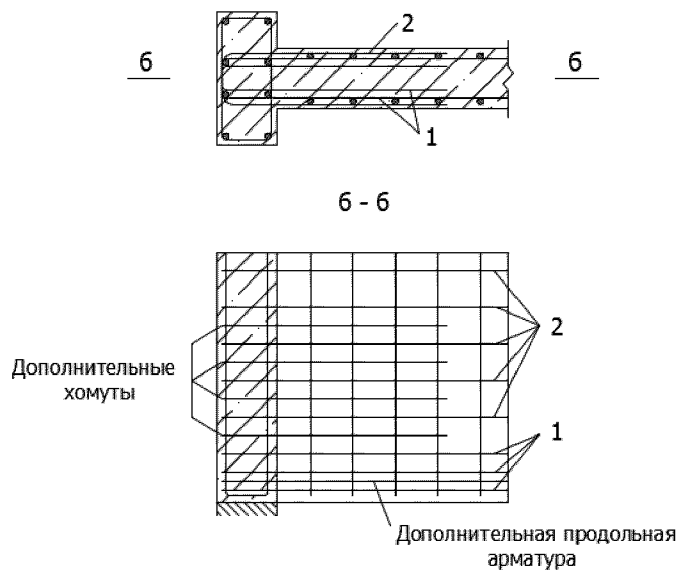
Армирование загруженной сверху однопролетной балки-стенки
